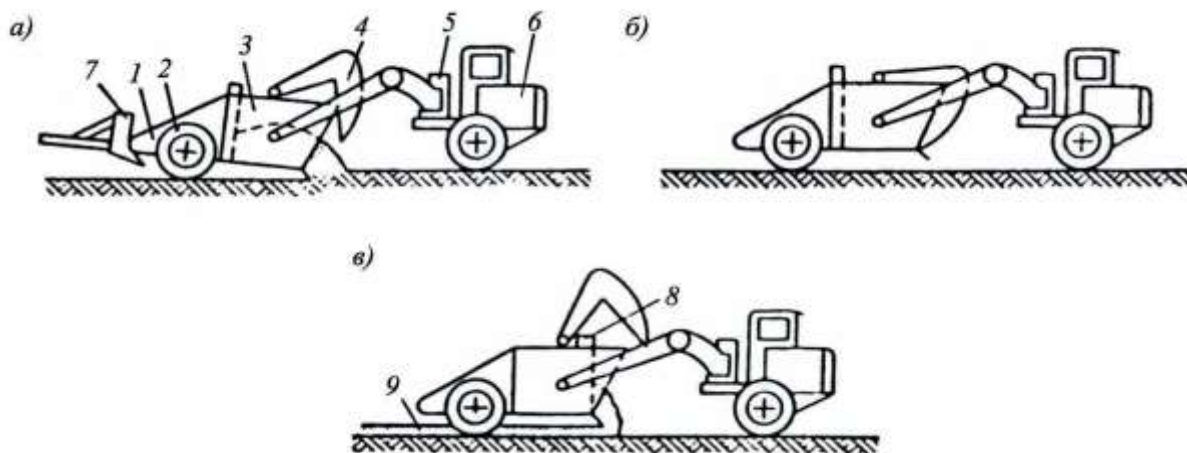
Рабочий цикл самоходного скрепера с пассивной загрузкой: а – загрузка ковша; б – транспортное положение; в – разгрузка ковша; 1 – буфер; 2 – заднее колесо; 3 – ковш; 4 – передняя заслонка; 5 – поворотно-сцепное устройство; 6 – одноосный тягач; 7 – толкающее устройство; 8 – разгрузочное устройство; 9 – слой выгруженного и спланированного грунта.
